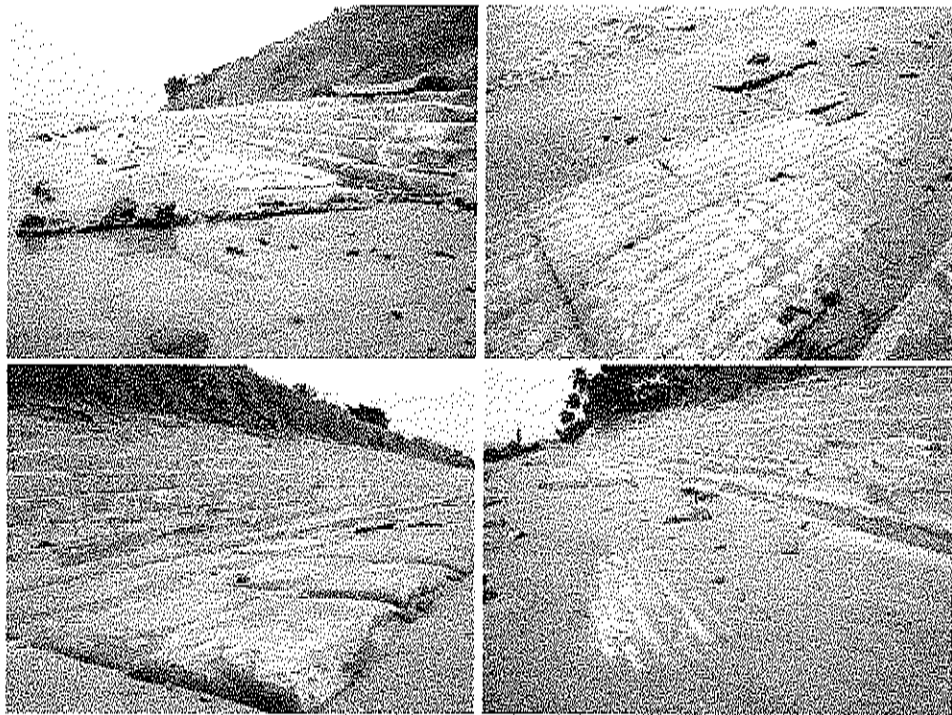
Rebaixamento do terreno natural e afloramento da fundação (Praia de Japaratinga/AL).
